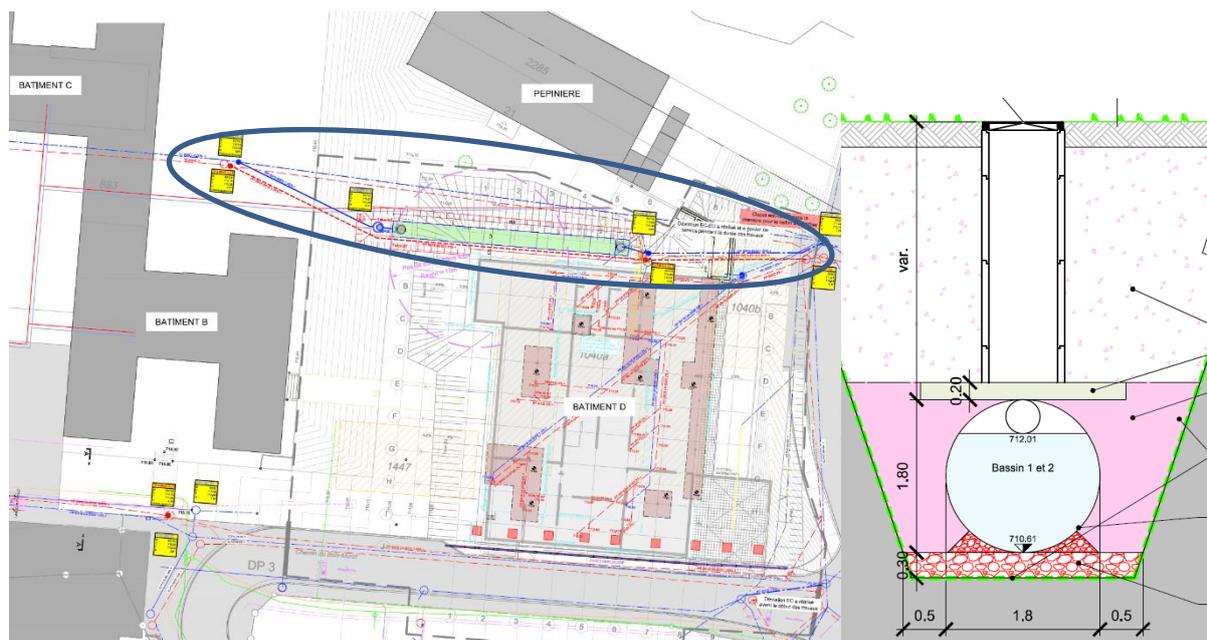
Plan de situation des travaux de canalisations et de rétention du secteur Nord
